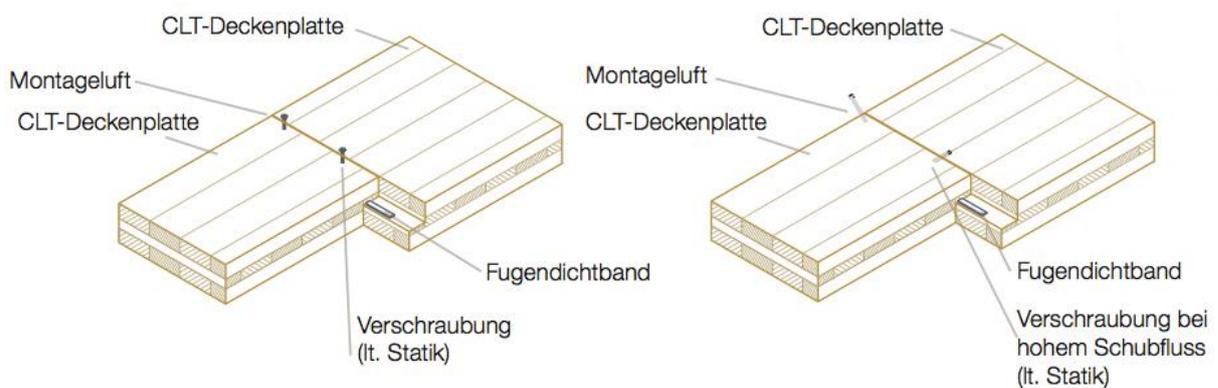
Deckenstoß – Stufenfalz¹⁸⁰
